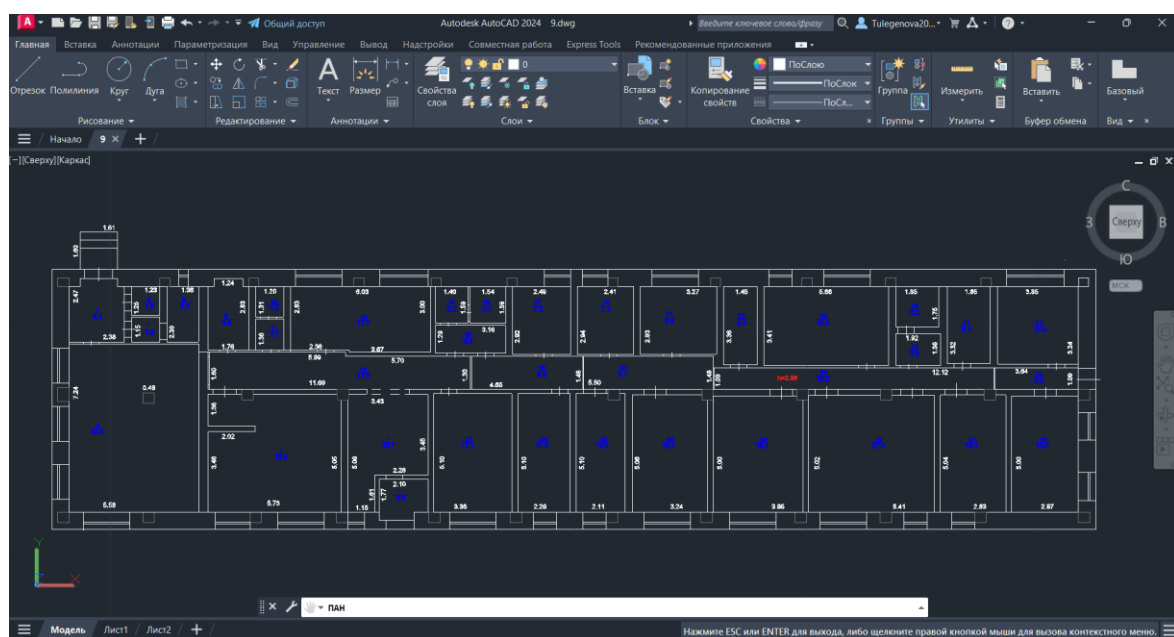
Поэтажный план здания в программе AutoCAD
